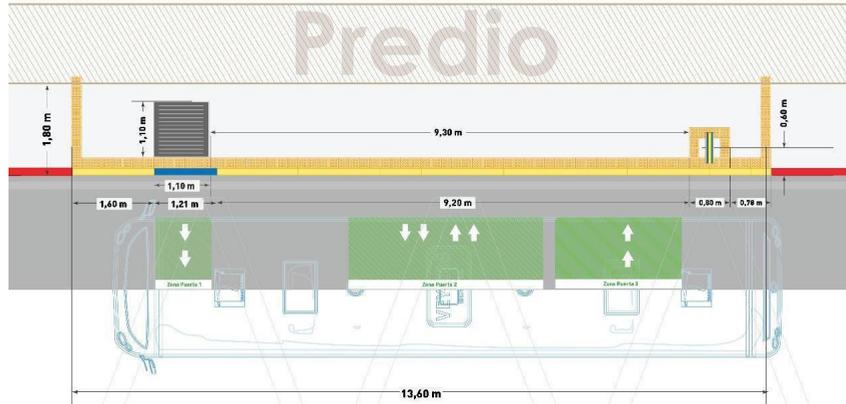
Zona paradero - caso C3; 1,8 a 1,99 metros * 13,60 metros - Estándar.
